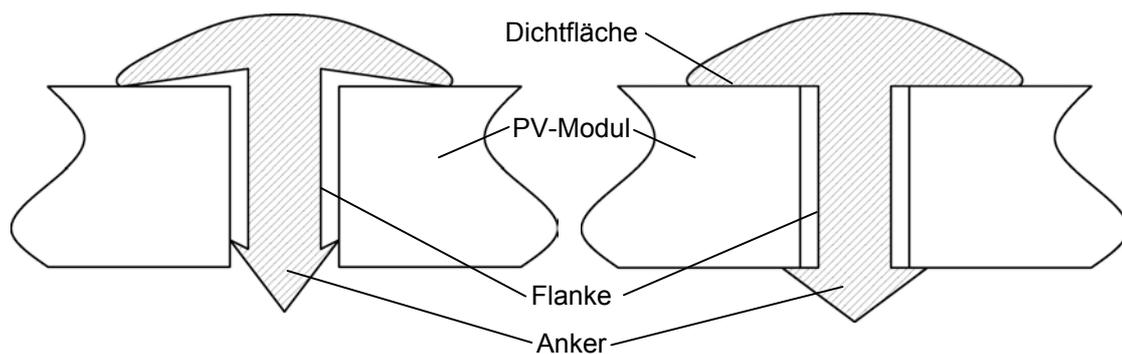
T-förmige Profildichtung beim Einbau (links) und eingebaut (rechts)
